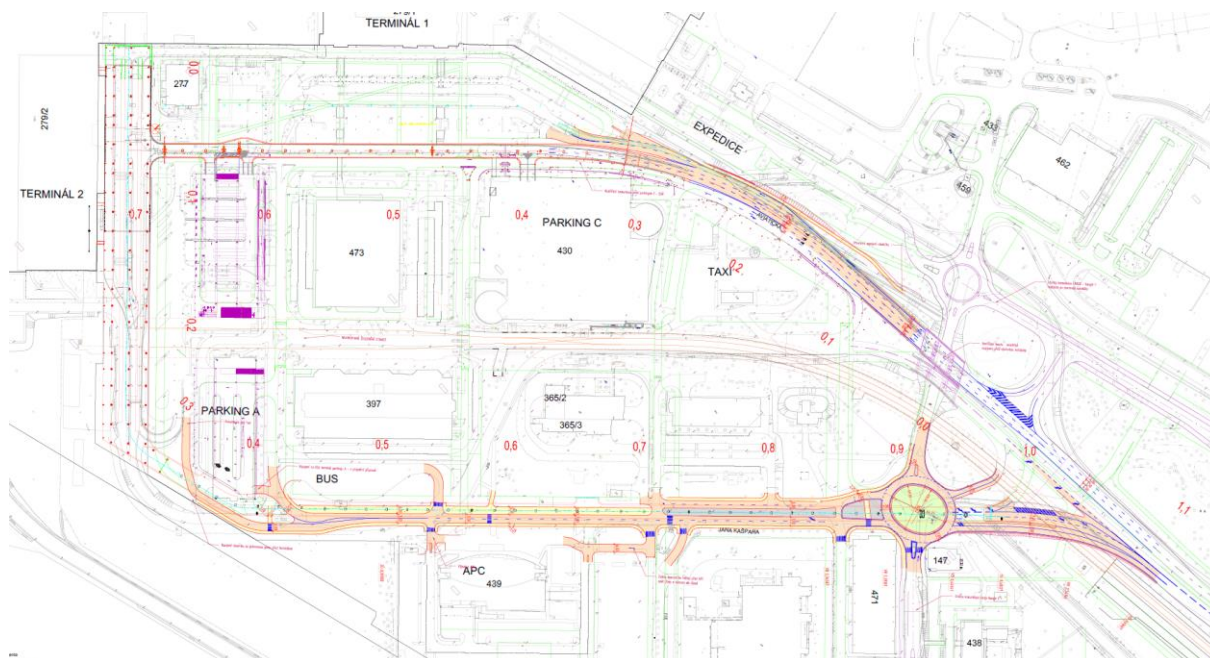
Situace navrhovaného stavu – základní názvosloví
